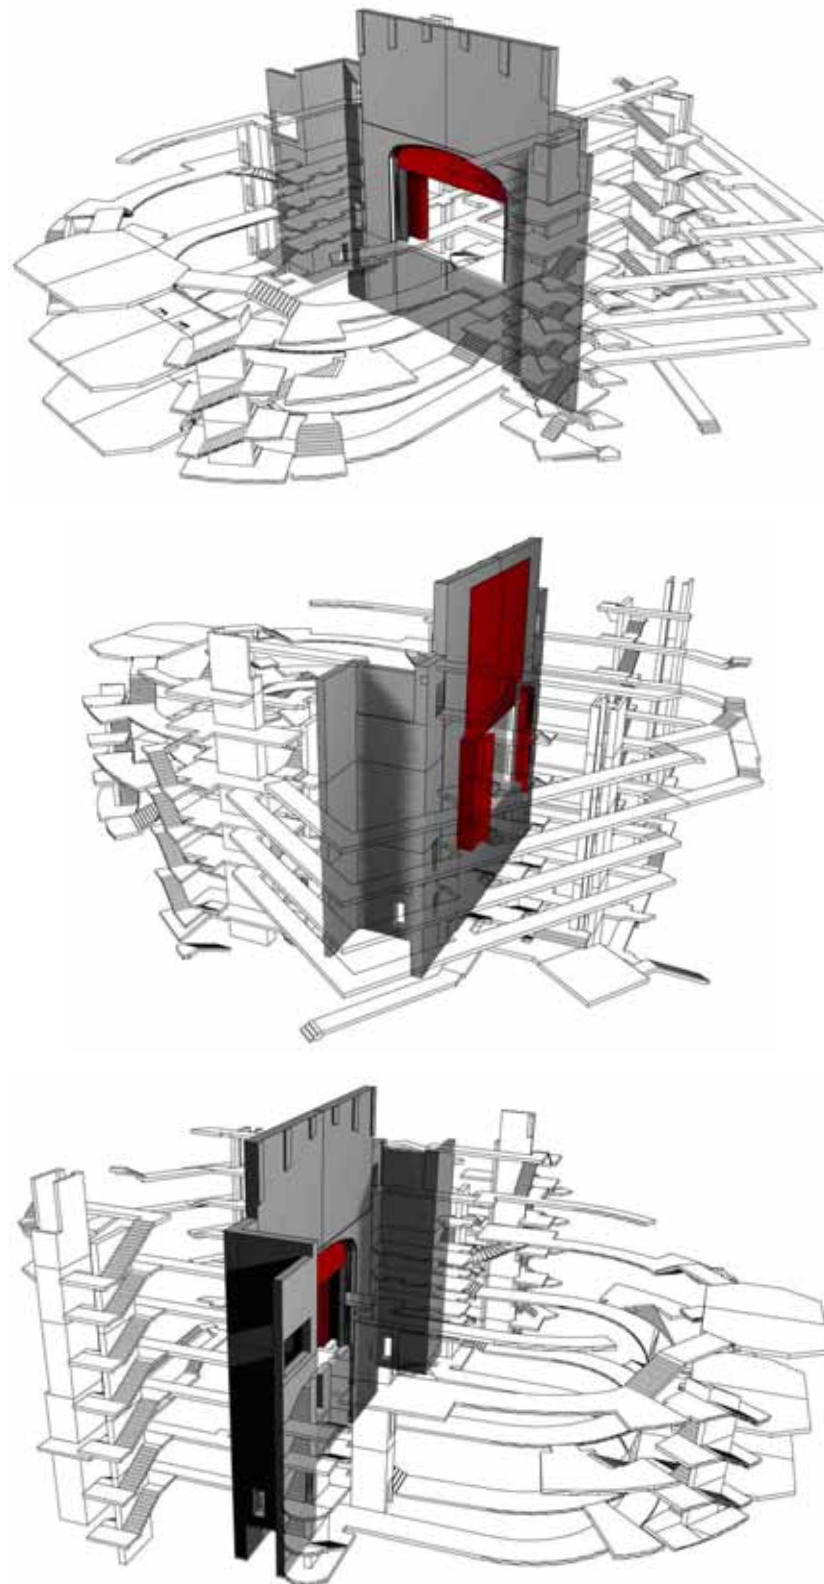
Einbindung von Grundrissinformationen in die räumliche Darstellung | Das obere Bild wird in zwei Arbeitsgängen hergestellt. Die verdeckt gerechnete Zeichnung des Längsschnitts wird über einen virtuellen Drucker ausgegeben, das Grundriss-Schema wird gerendert. Danach werden beide Grafiken in einem Bildbearbeitungsprogramm überlagert.
